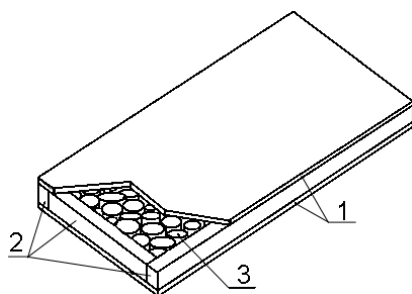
Трехслойный строительный щит: 1 – обшивки; 2 – бруски обвязки; 3 – торцовый заполнитель из круглой тонкомерной древесины
